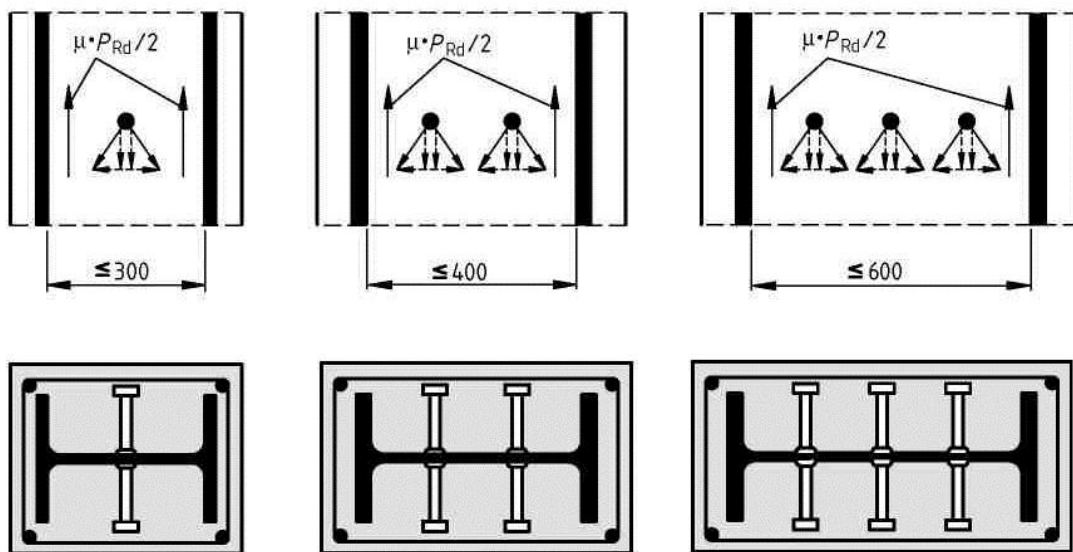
Дополнительные силы трения в сталежелезобетонных колоннах при наличии анкерных стержней, приваренных к стенке двутавра
